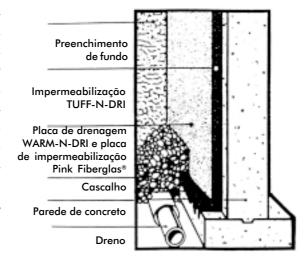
Exemplo de um sistema de impermeabilização para fundações.
